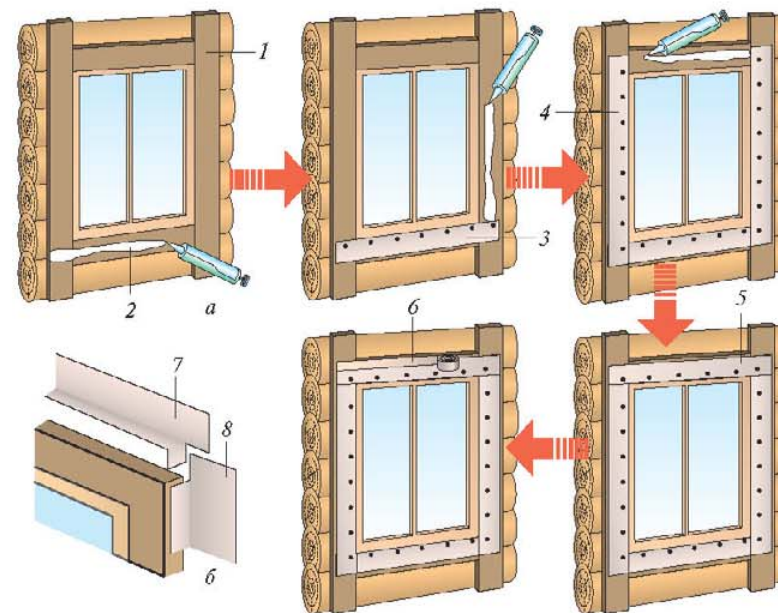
Гидроизоляция оконных и дверных проемов: а — заподлицо со стеной; б — выступающего из стены; 1 — обрешетка; 2 — силиконовый герметик; 3 — нижний фартук из кровельной жести; 4 — то же, боковой; 5 — то же, верхний; 6 — алюминиевый скотч или герметик; 7 — верхний Г-образный фартук из кровельной жести; 8 — то же, боковой
